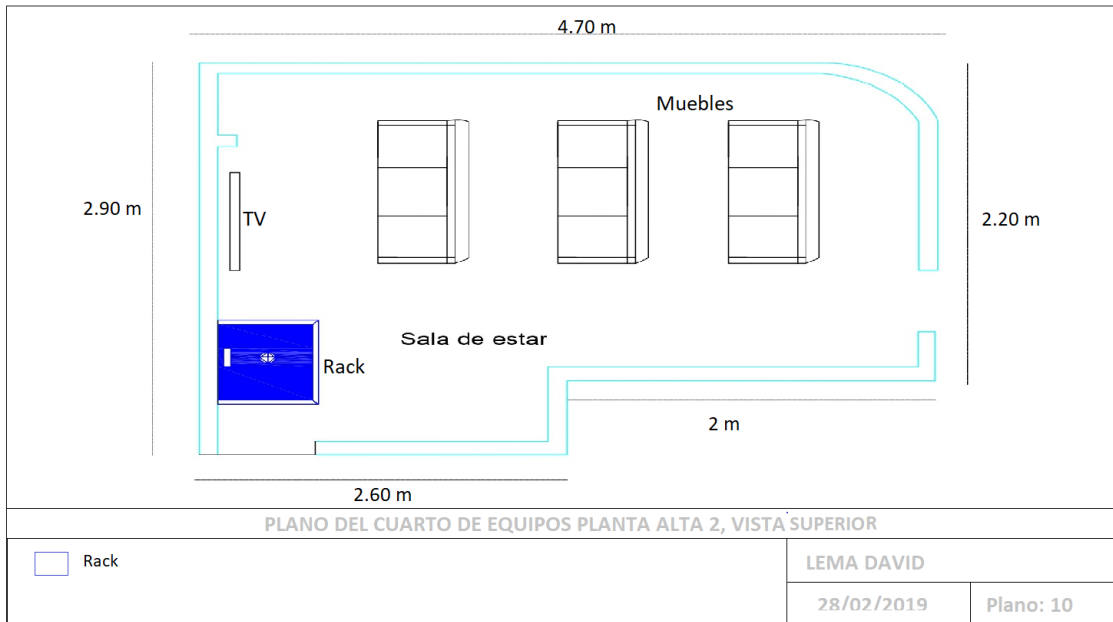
Plano de cuarto de equipos planta alta, vista superior.
